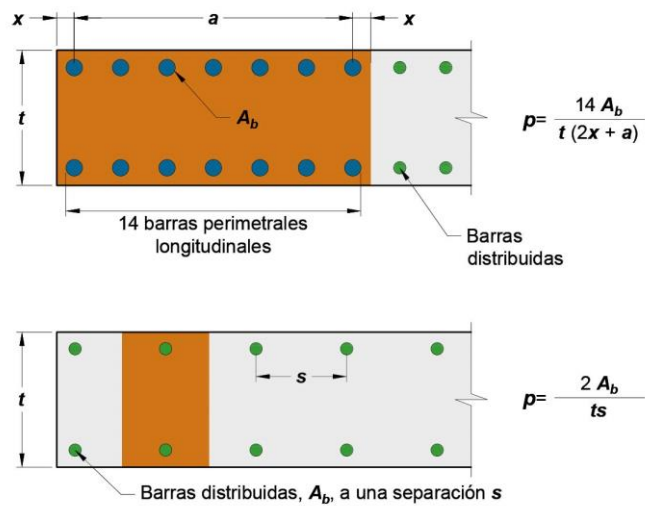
e – Cuantía de refuerzo longitudinal (vertical) en orillas de un muro de ductilidad alta (adaptada de ACI CODE-318-19)
